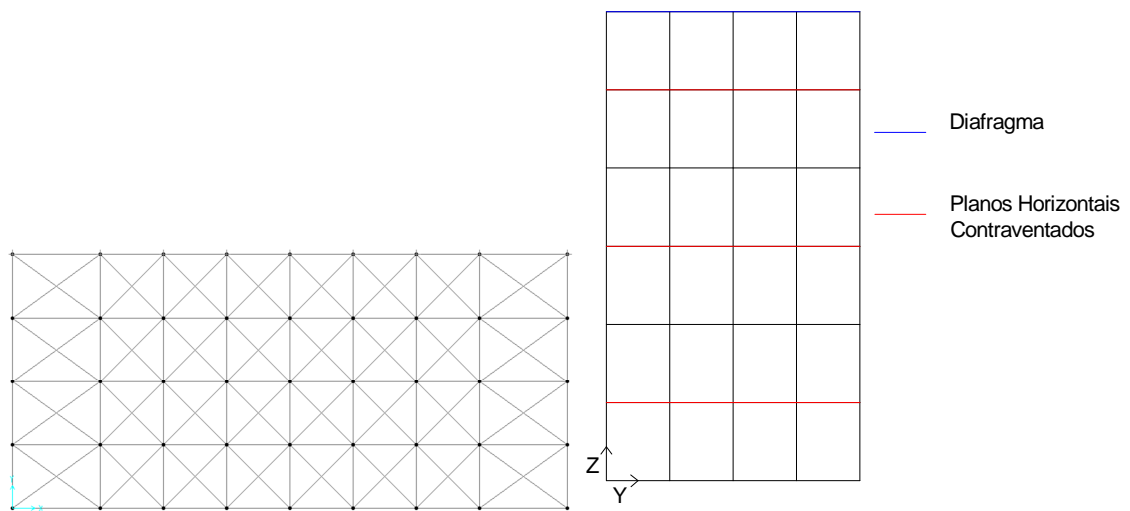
Configuração dos Planos de Contraventamento Horizontal Com Elementos de Contraventamento Pequenos
